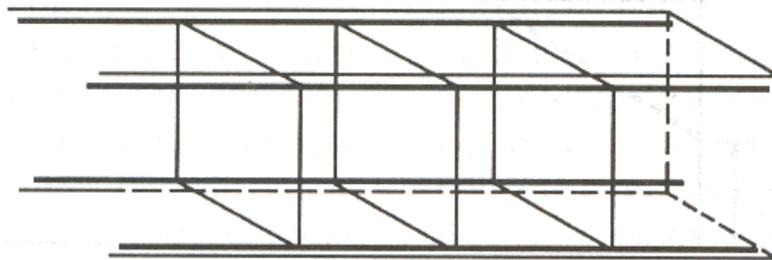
Arreglos de refuerzo de torsión recomendado.
